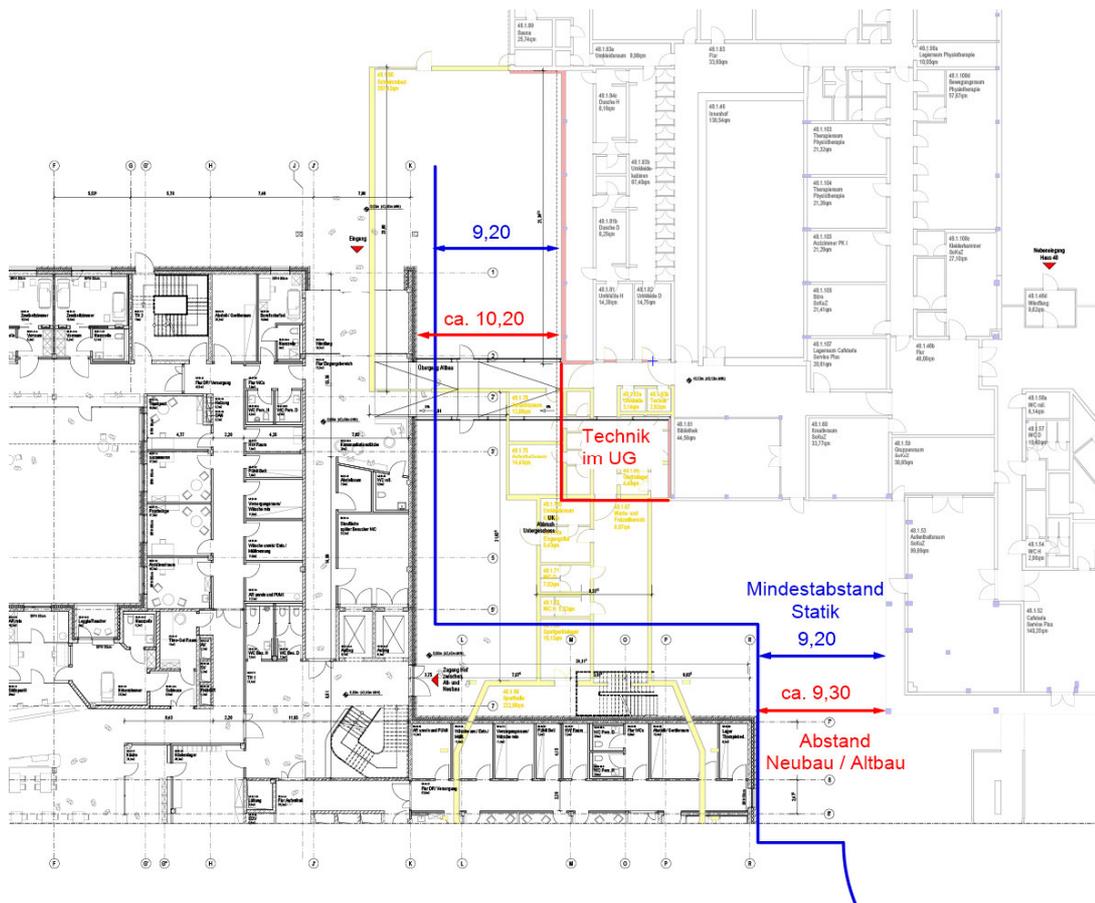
\_ Grundrisslupe Anschlussbereich derzeitiger Planungsstand
